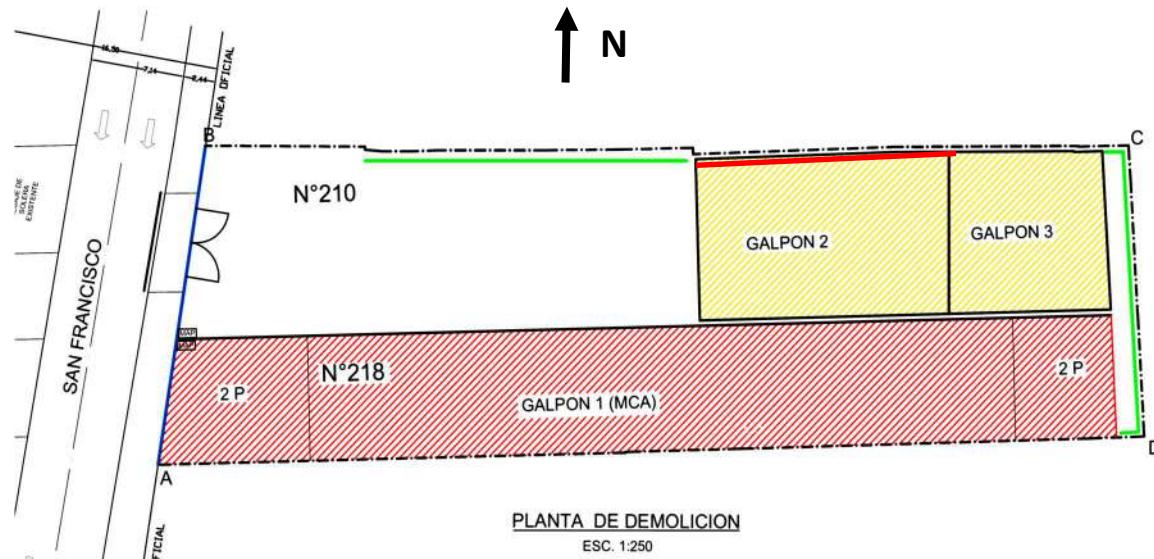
Plano vista en planta con la sectorización de las zonas de demolición.
